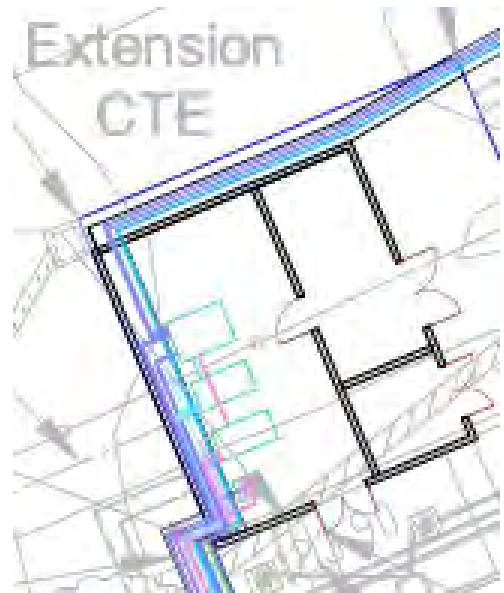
Plan d'implantation du CTE TR3 et TR4
